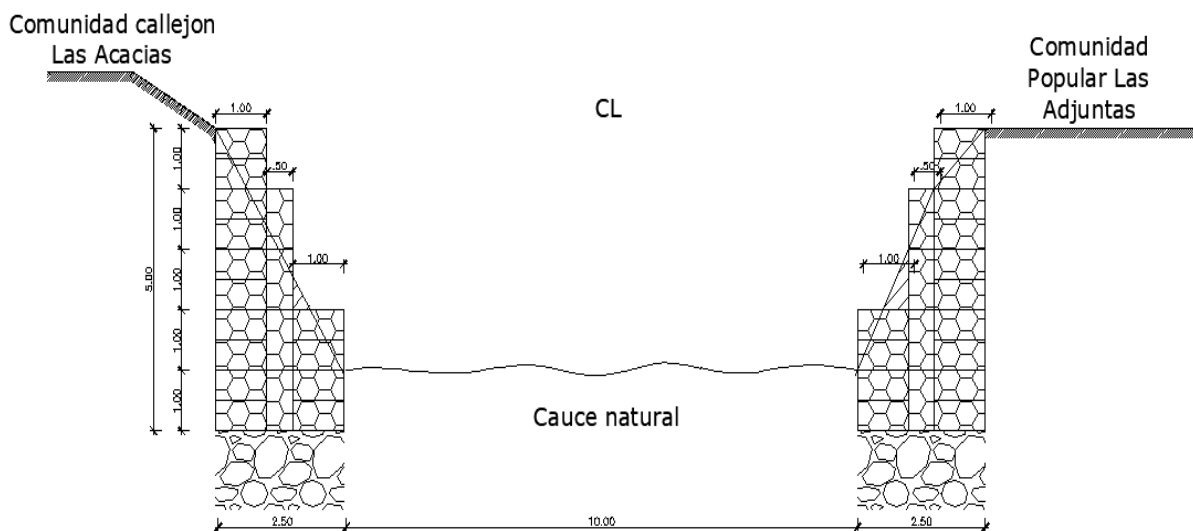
Detalle de canalización con muro de gaviones diseñado
